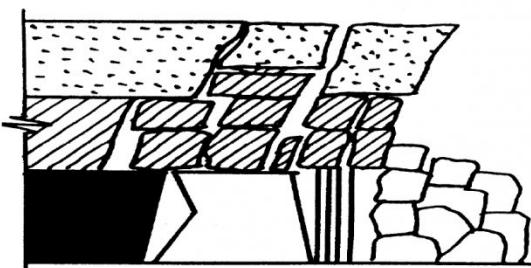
Вторая форма разрушения кровли над подготовительной выработкой
